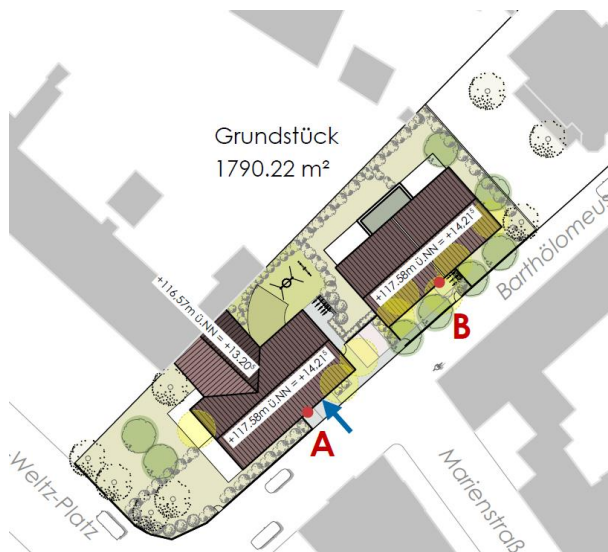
Lageplan, Eckert GmbH, 19.03.2021, ohne Maßstab
